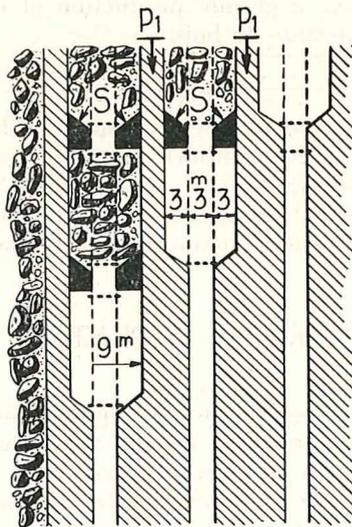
Chambres élargies de 3 m de chaque côté.
